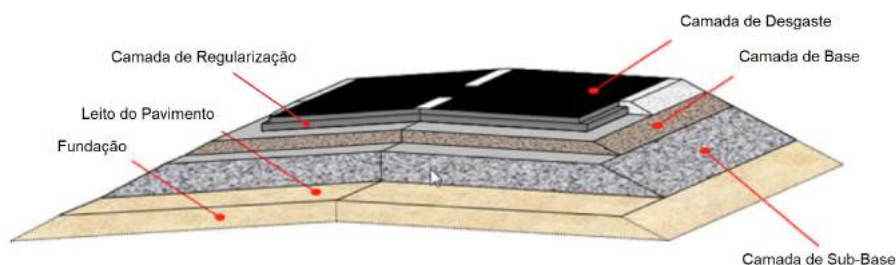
Constituição de um pavimento tipo (adaptado de EAPA [5]).
